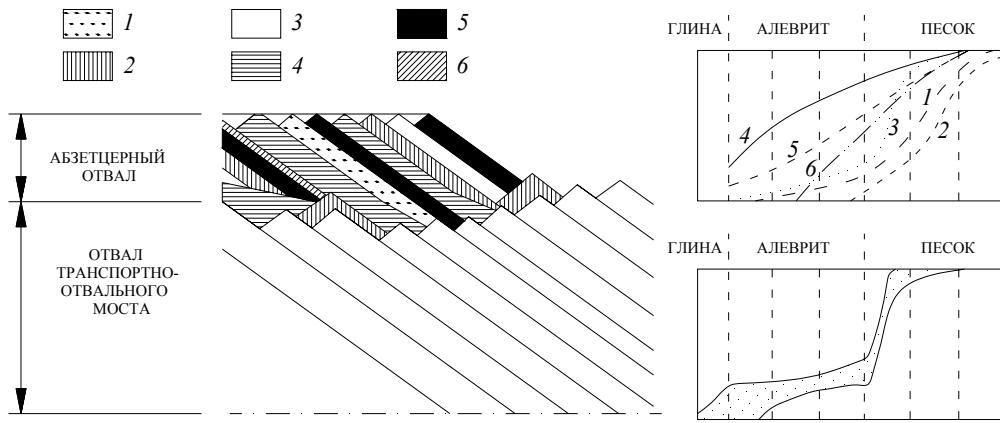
Строение отвала под ЦХ Крёберн: 1 — речной песок; 2 — среднезернистый песок; 3 — мелкозернистый песок; 4 — каолиновая глина; 5 — почвенный слой; 6 — зола ТЭЦ
